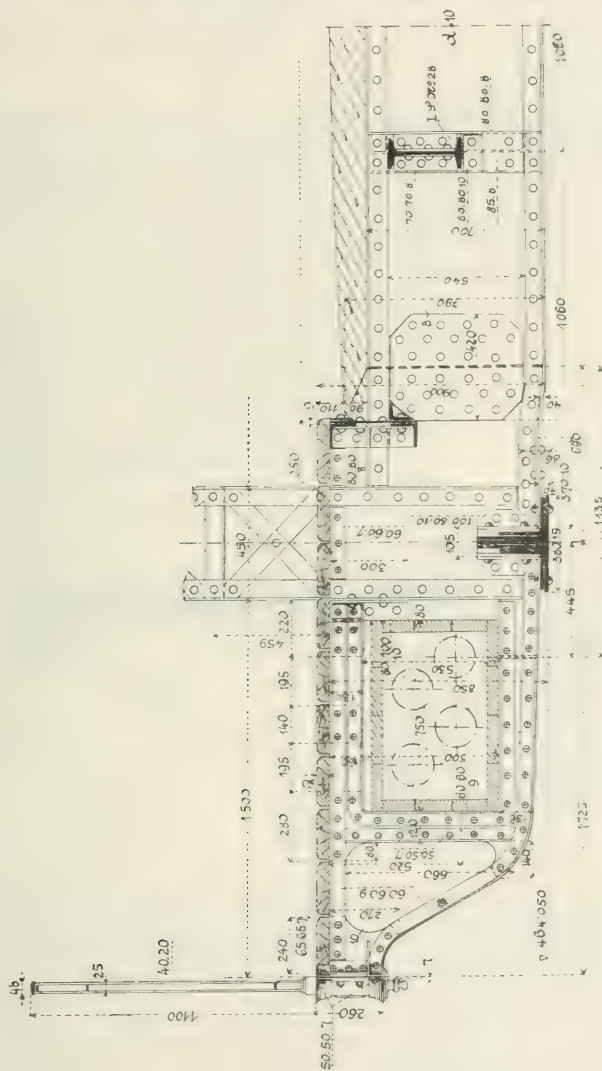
Straßenbrücke in Freiburg im Breisgau (Deutsche Bauzeitung 1903)
